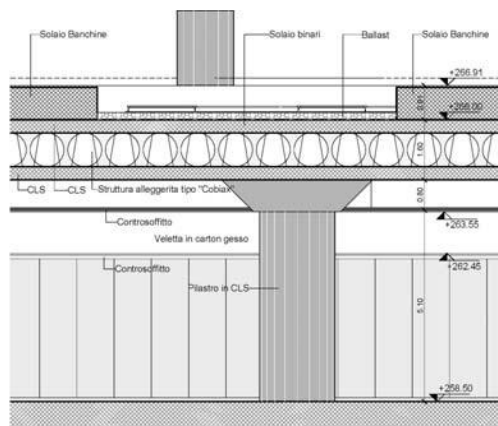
Estratto Tav 3.3.7 - Dettaglio piastra strutturale della piazza ipogea
